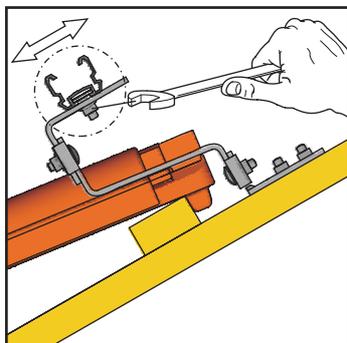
Avvitare saldamente i profilati alla sezione superiore del gancio da tetto
